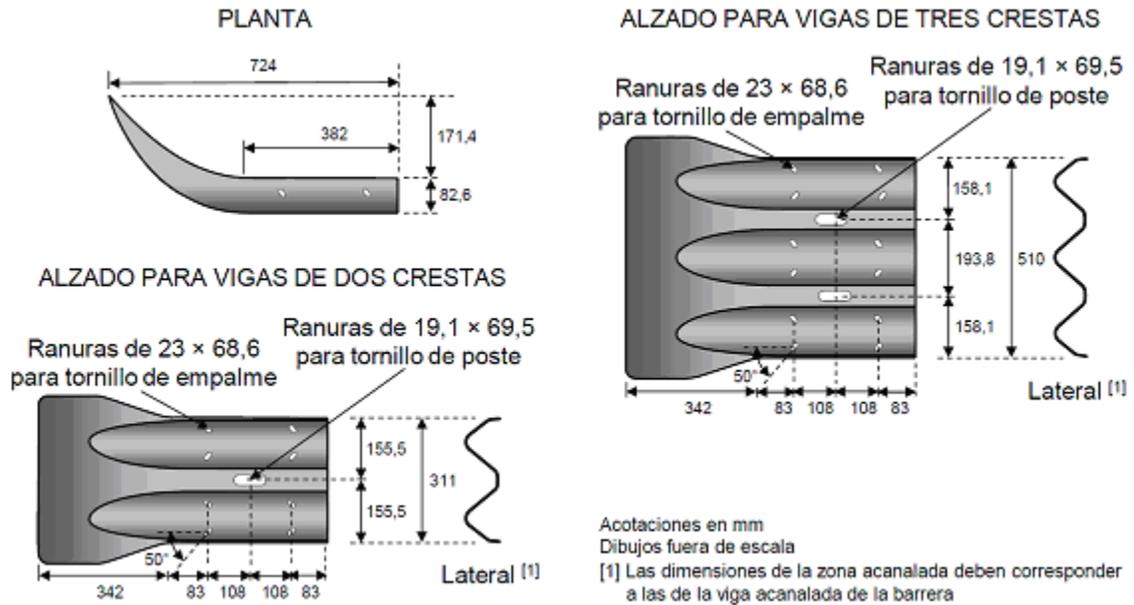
Secciones terminales sencillas para vigas acanaladas de dos y de tres crestas (OD-4.4.2/S)
